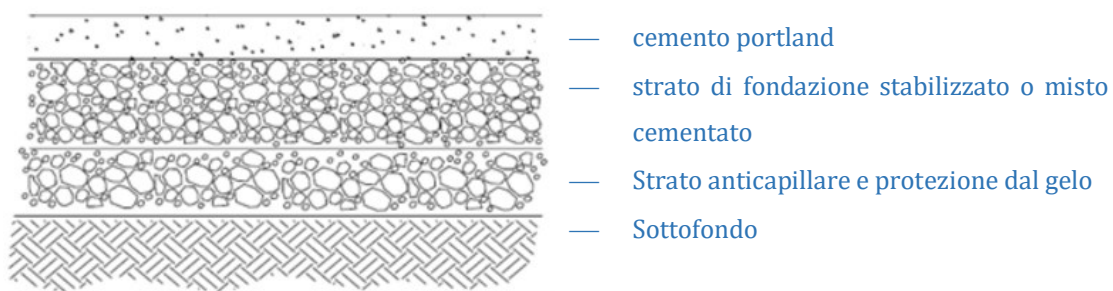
1. Elenco Strati che Interessano una Pavimentazione Rigida.
